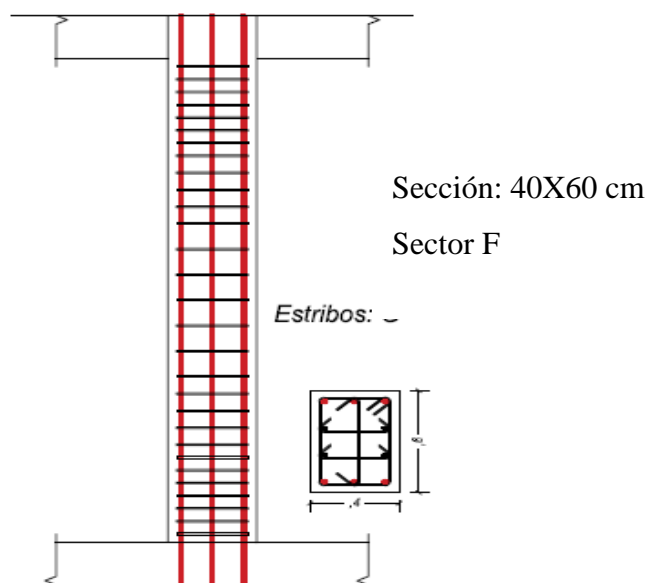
Detalle de Columna en Base Aislada (F)
